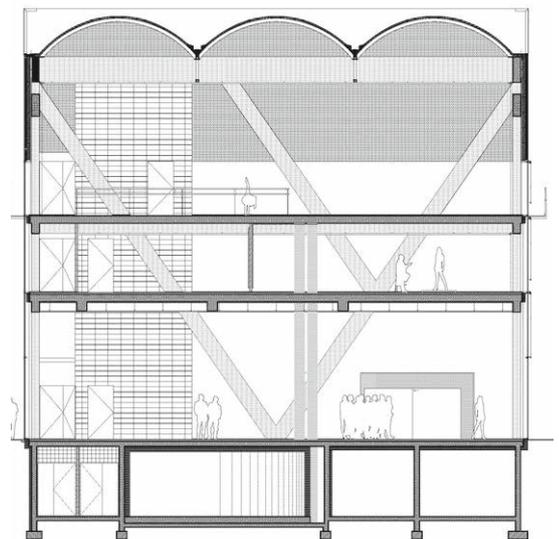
Sporthalle, Saint-Blaise, Schnitt
